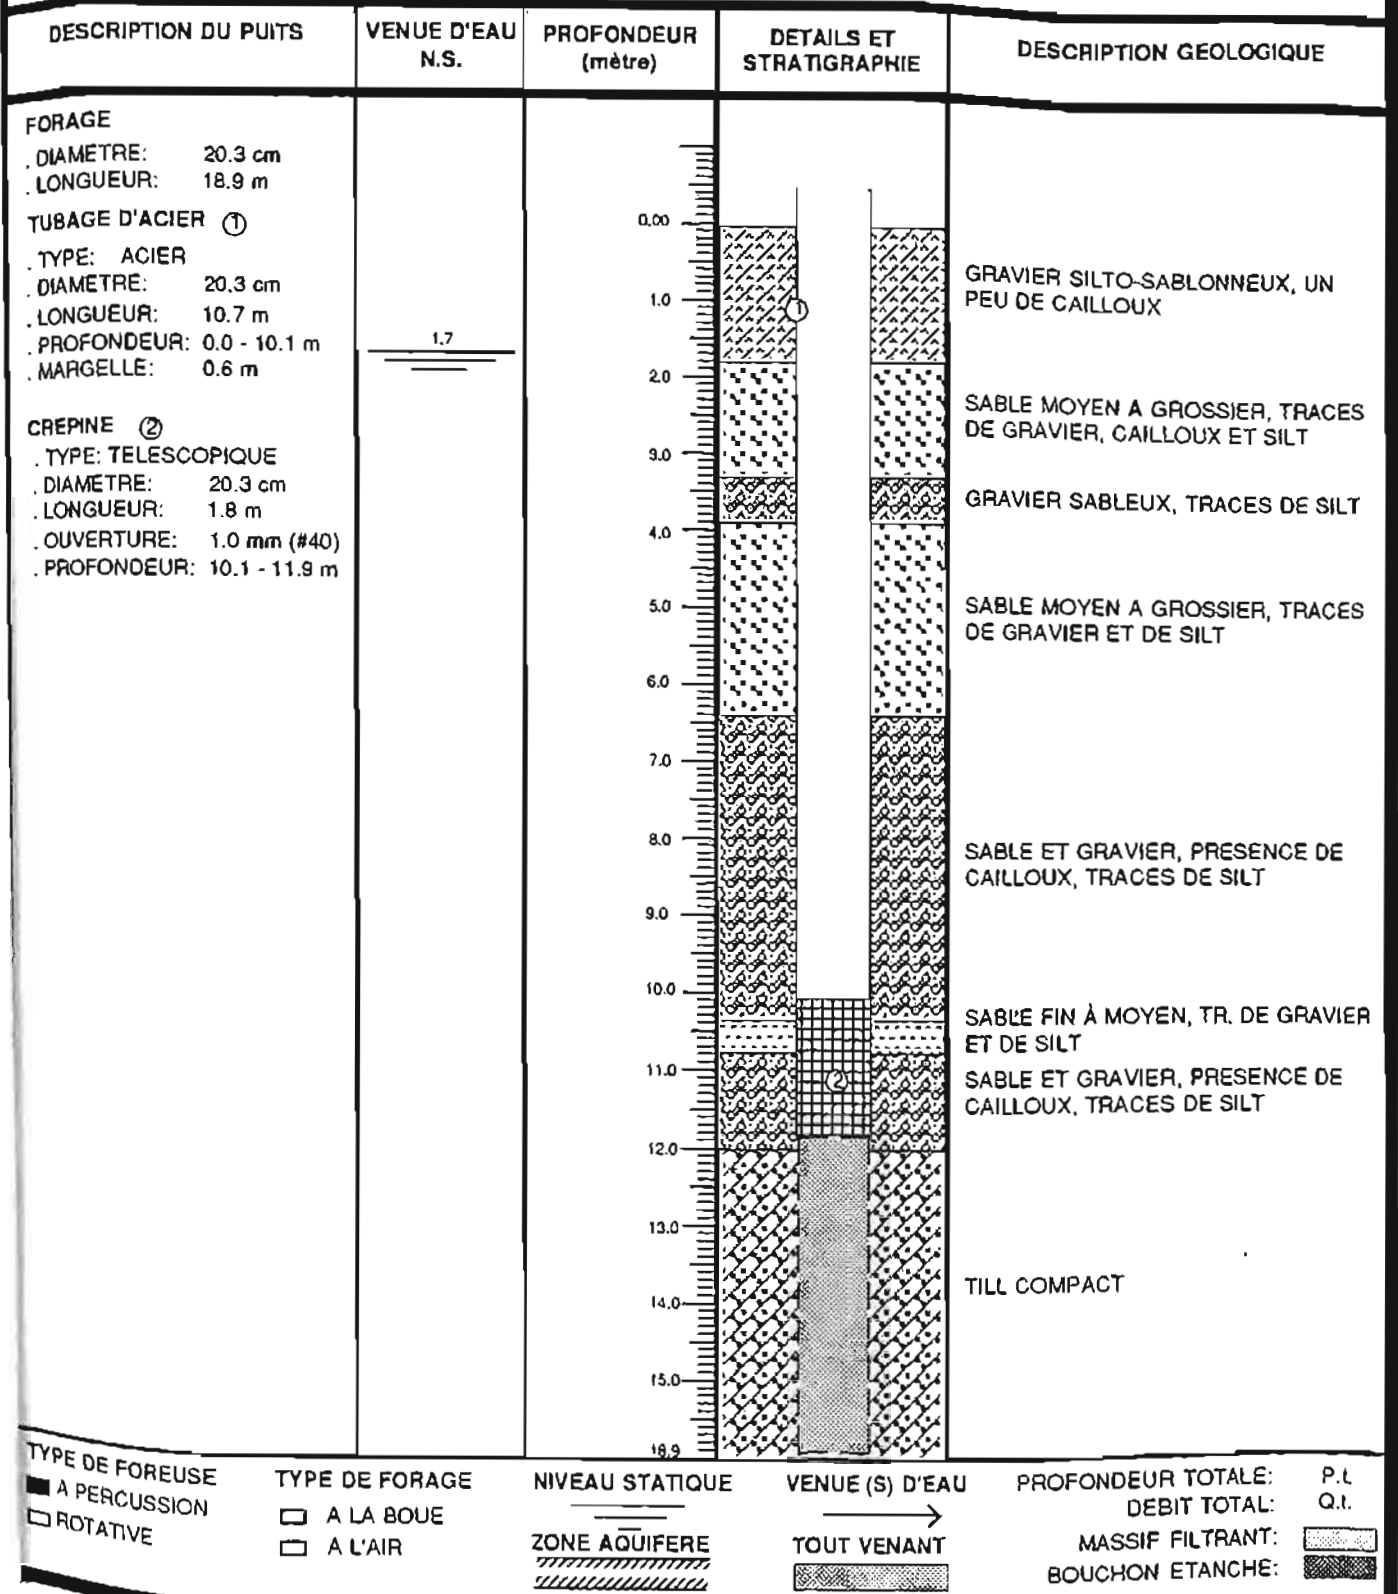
SCHEMA D'INSTALLATION DU PUIITS D'ESSAI PE-1
